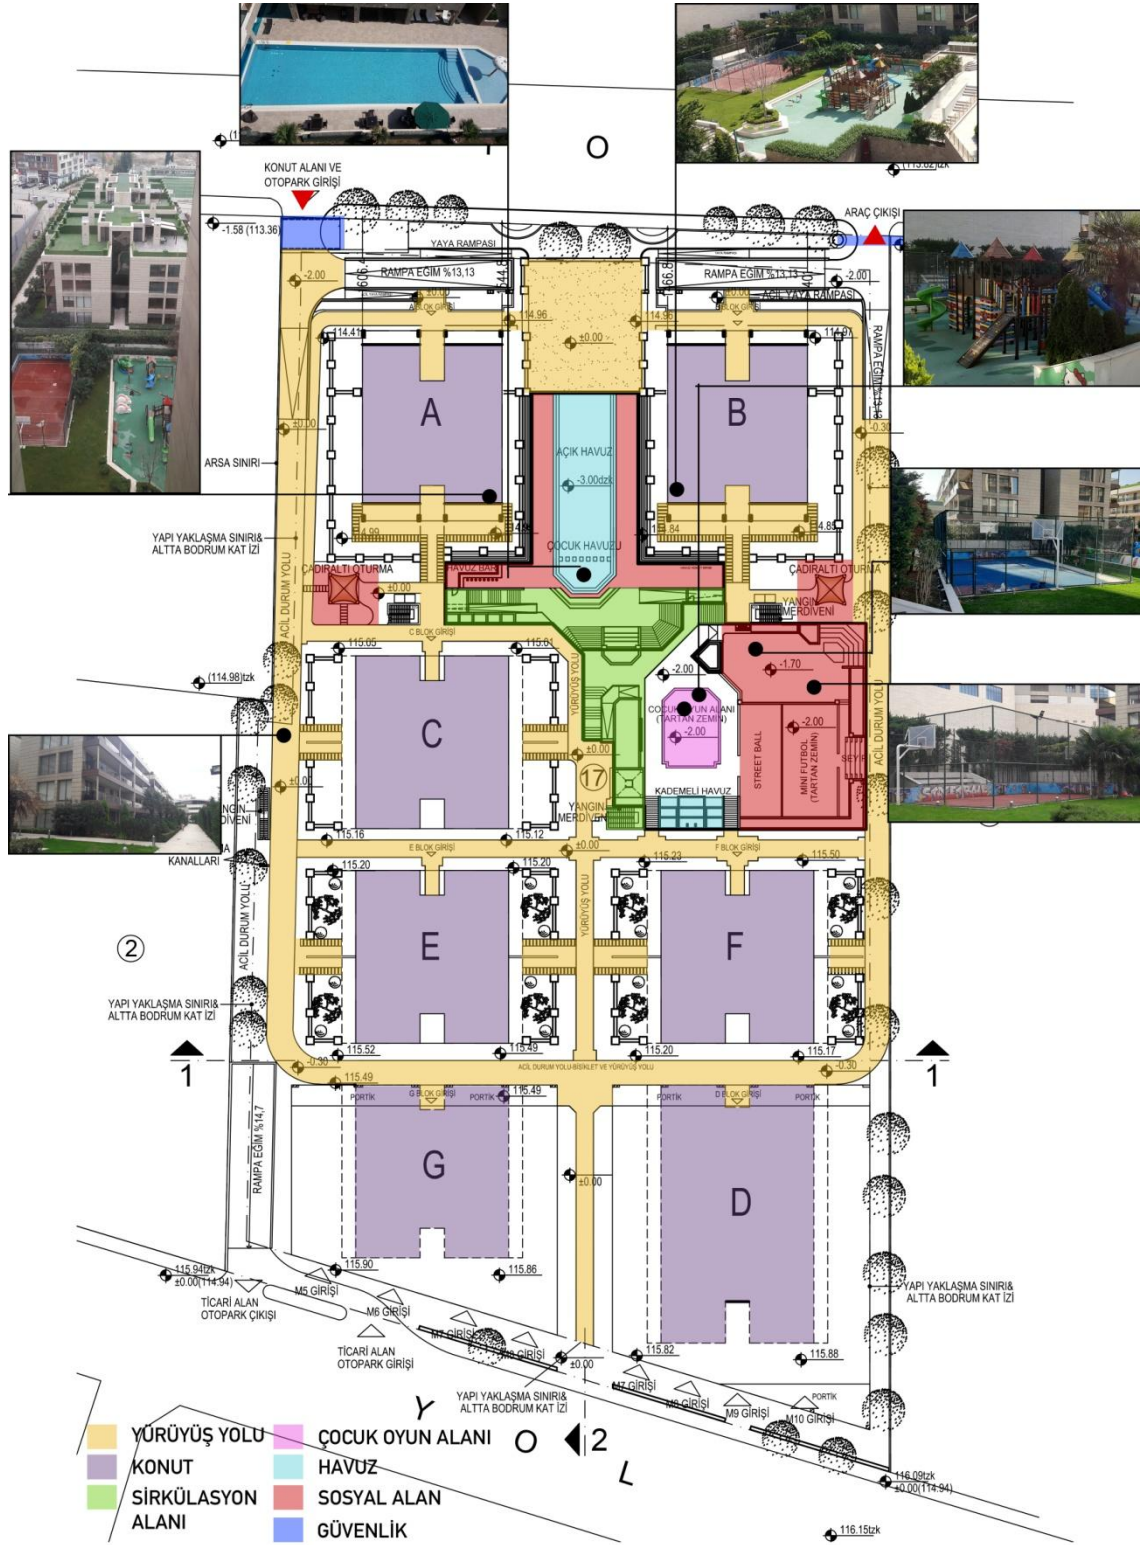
Harmony Towers projesi sosyal alan kat planı
